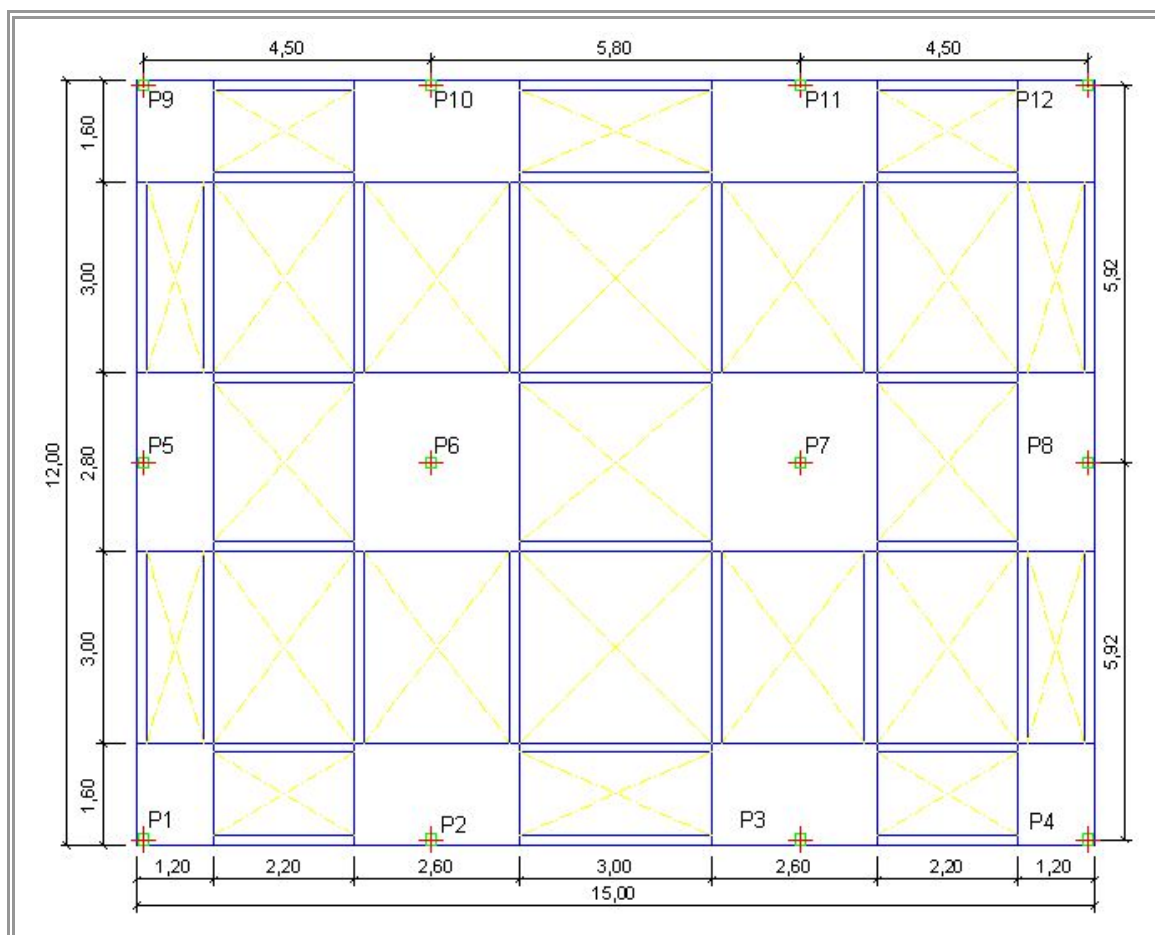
Esquema en planta de la cimentación estudiada. 15,00 x 12,00
